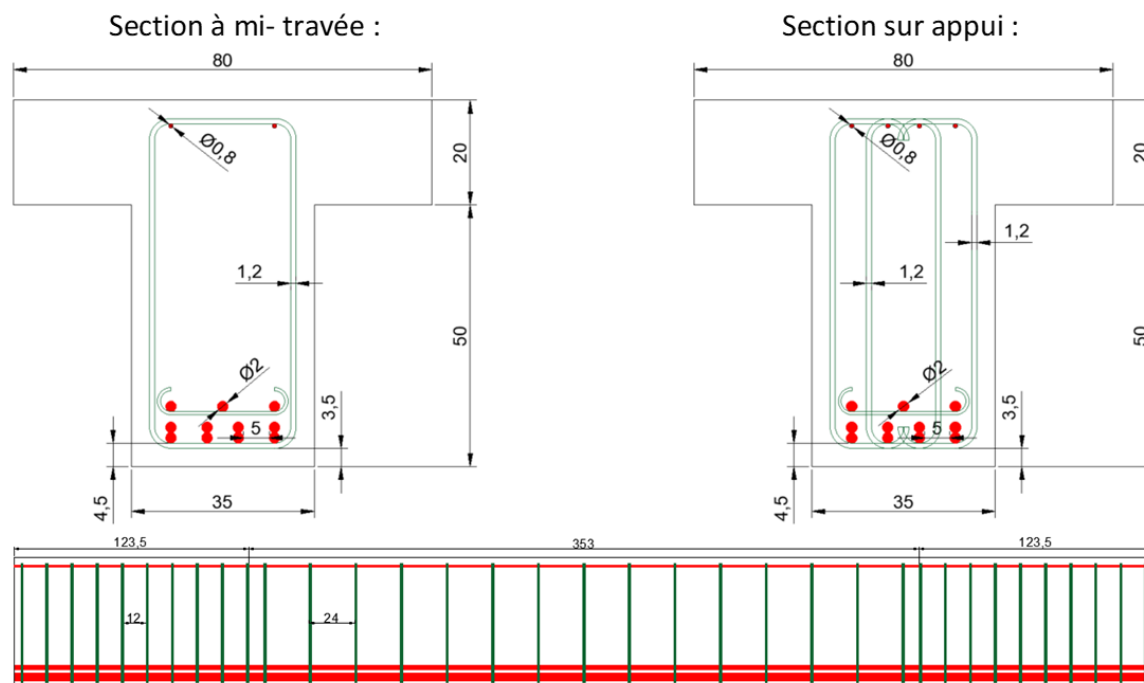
Disposition des armatures PRF longitudinales et transversales (effort tranchant) dans la section en T de la poutre étudiée à mi-travée et sur appuis issue de l'exemple du guide (AFGC, 2021)
